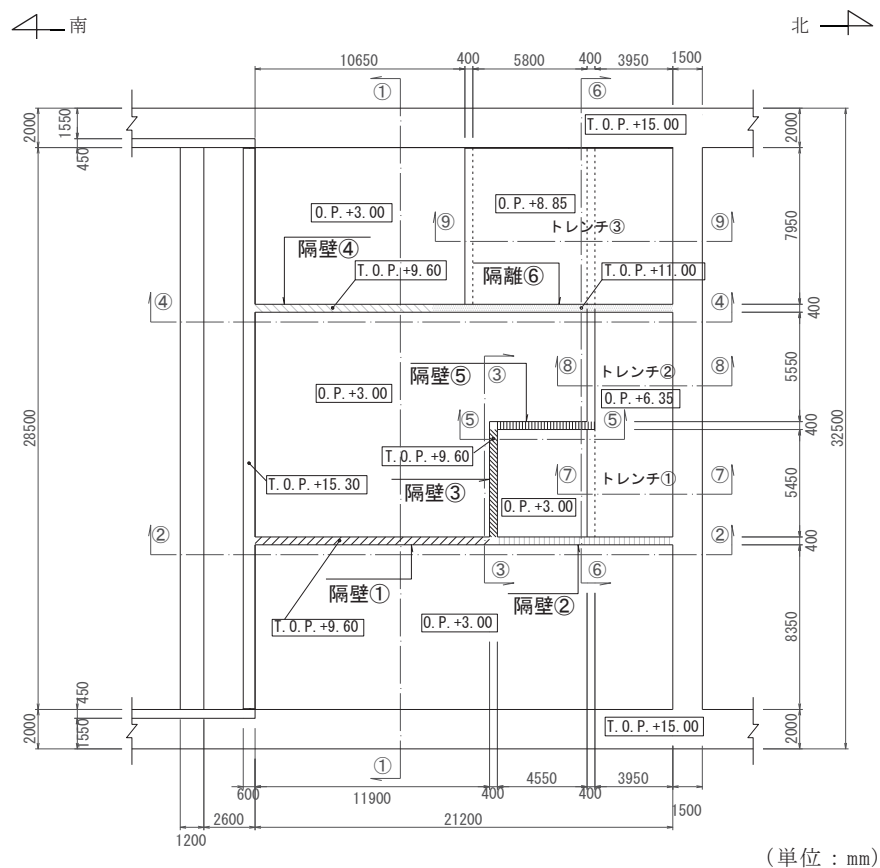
海水ポンプ室補機ポンプエリアの平面図
